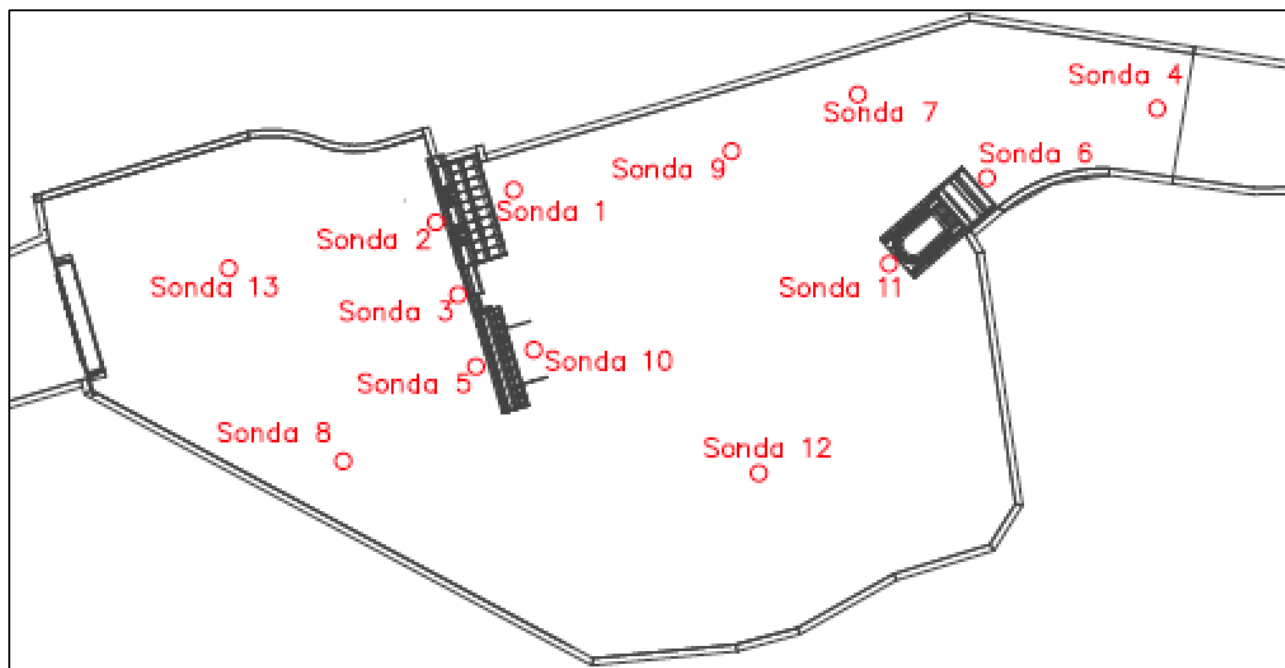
Planimetria con la localizzazione delle sonde utilizzate nel modello.
